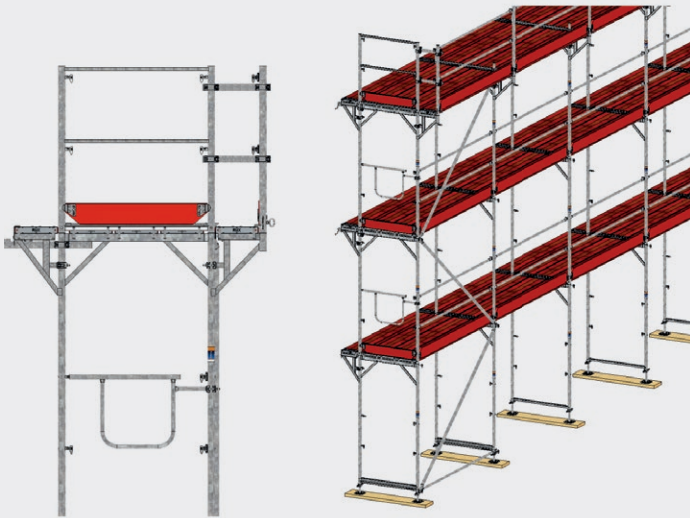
Gerüst mit einbohliger Verbreiterungskonsolen außen
